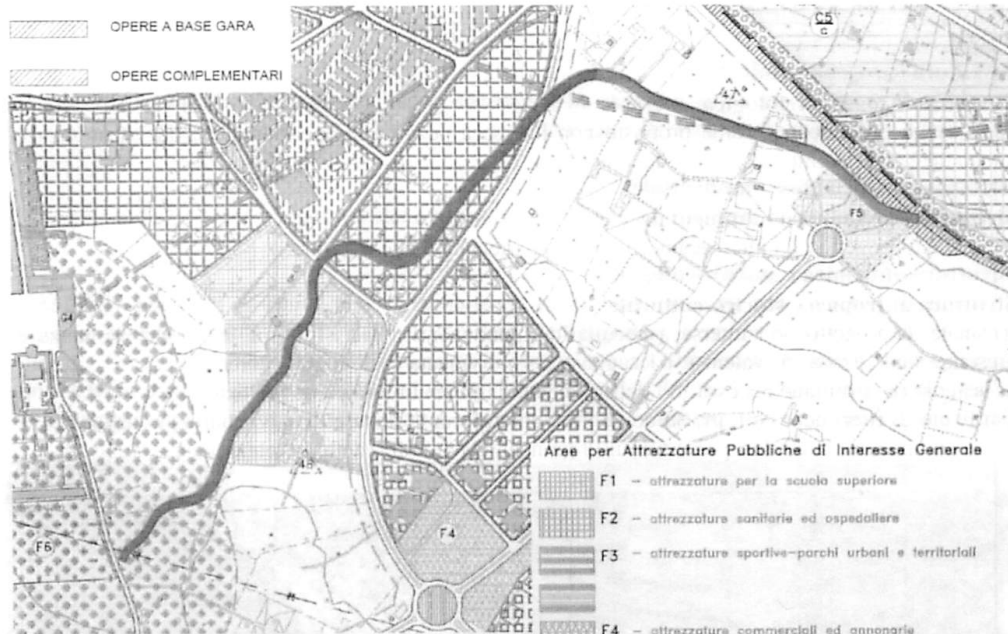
Inquadramento dell'intervento su stralcio PRG
